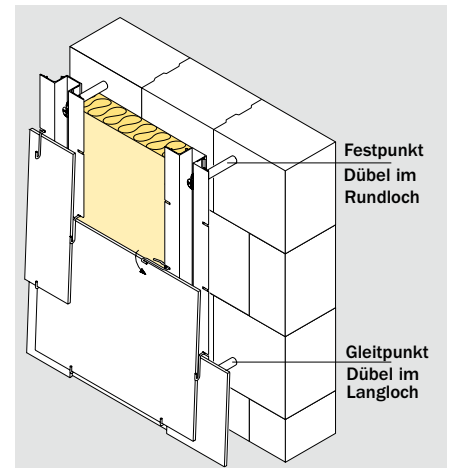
Aluminium-Unterkonstruktion mit Abstandsdübeln
